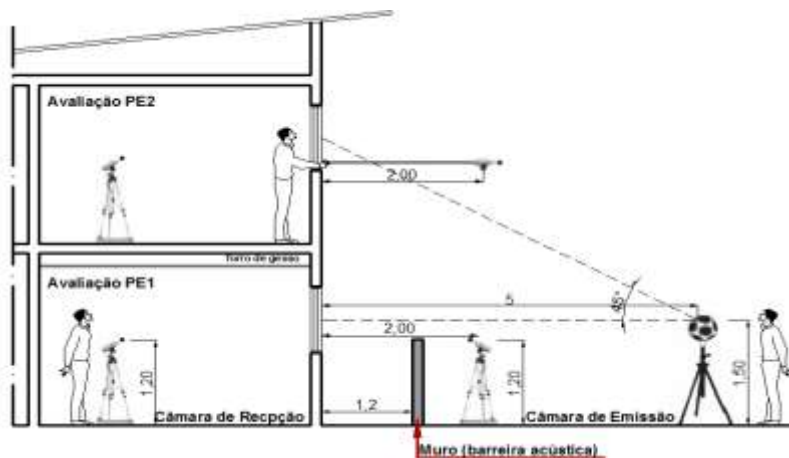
Corte esquemático medições de isolamento sonoro nas fachadas do Objeto 02.
